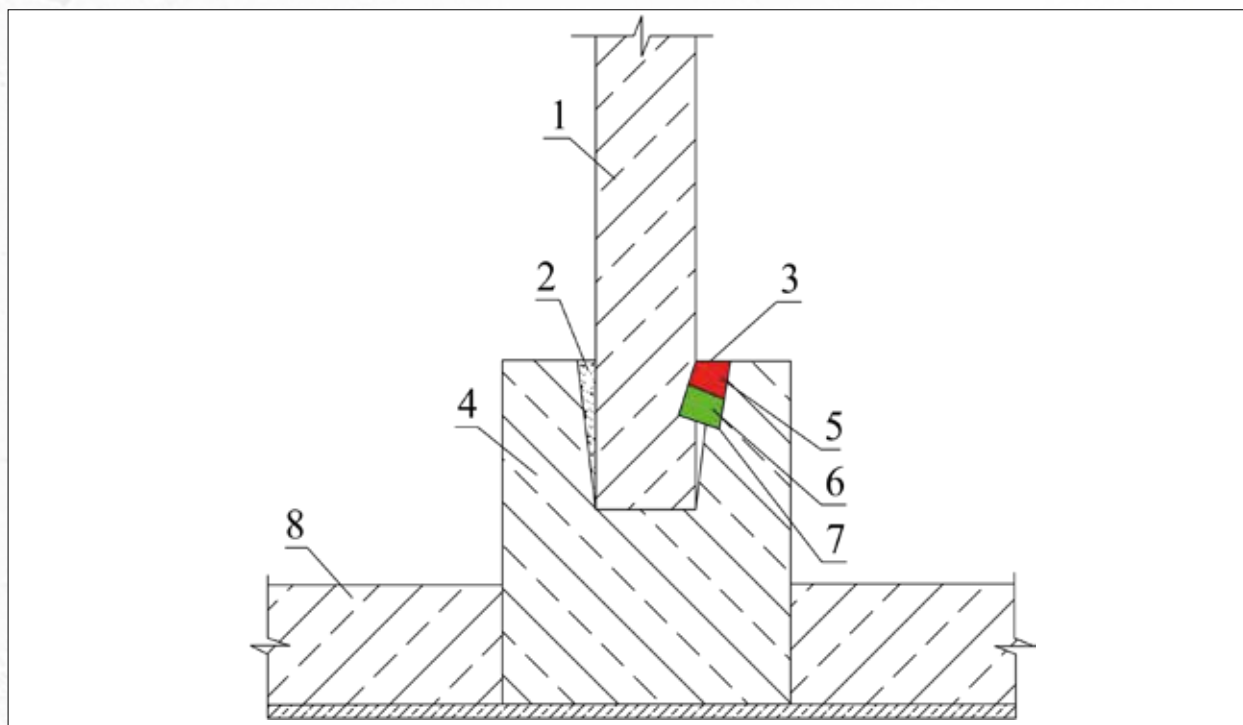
Схема гидроизоляции примыканий стеновых панелей к фундаменту: 1 – стеновая панель; 2 – цементно-песчаный раствор; 3 – штраба, обработанная раствором смеси «Пенетрон»; 4 – фундамент; 5 – «Пенекрит»; 6 – «Пенеплаг»/«Ватерплаг»; 7 – штраба; 8 – днище
